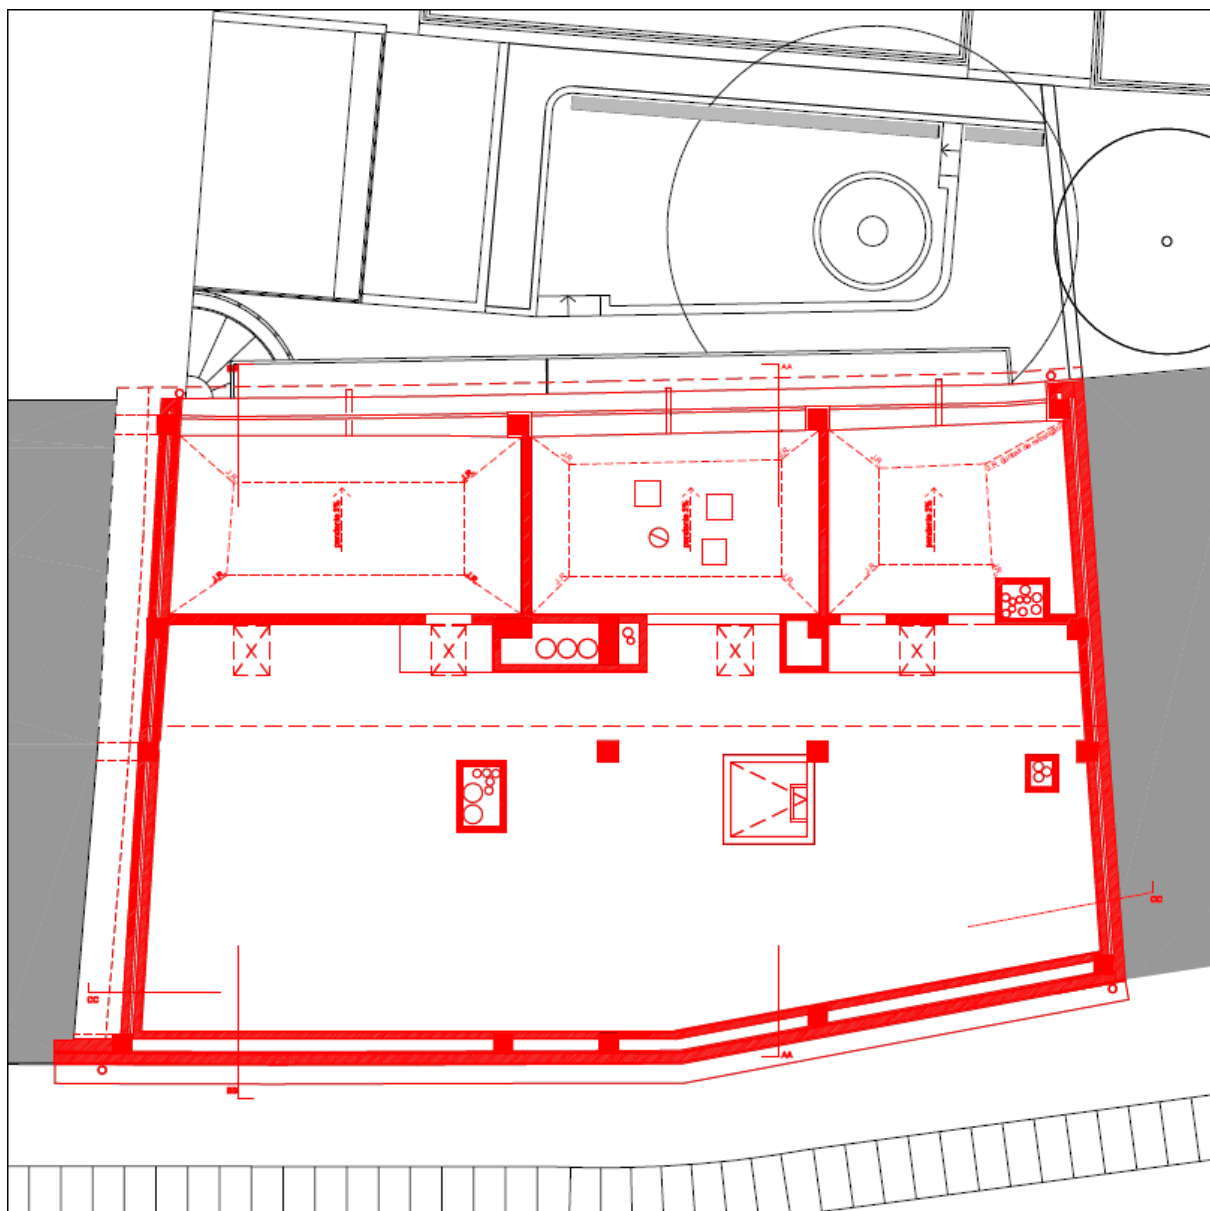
Planta da laje de esteira do edifício 4 em estudo
